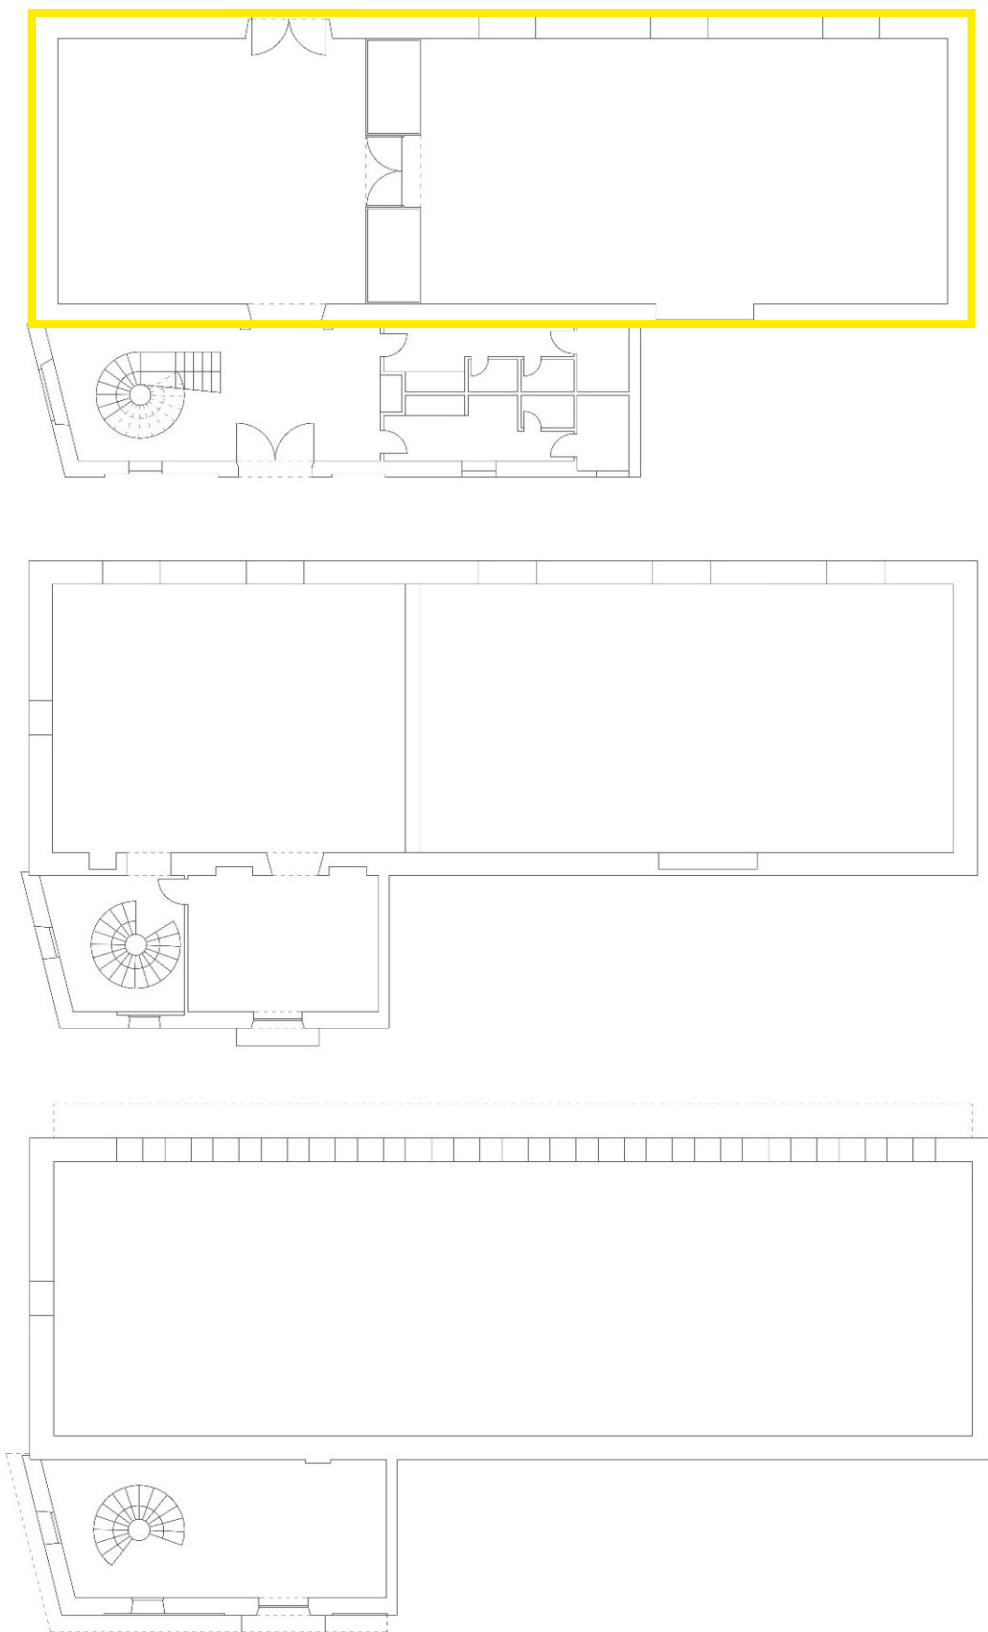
Planos actuales tras la reforma del S. XX. Señalado Volumen original.
